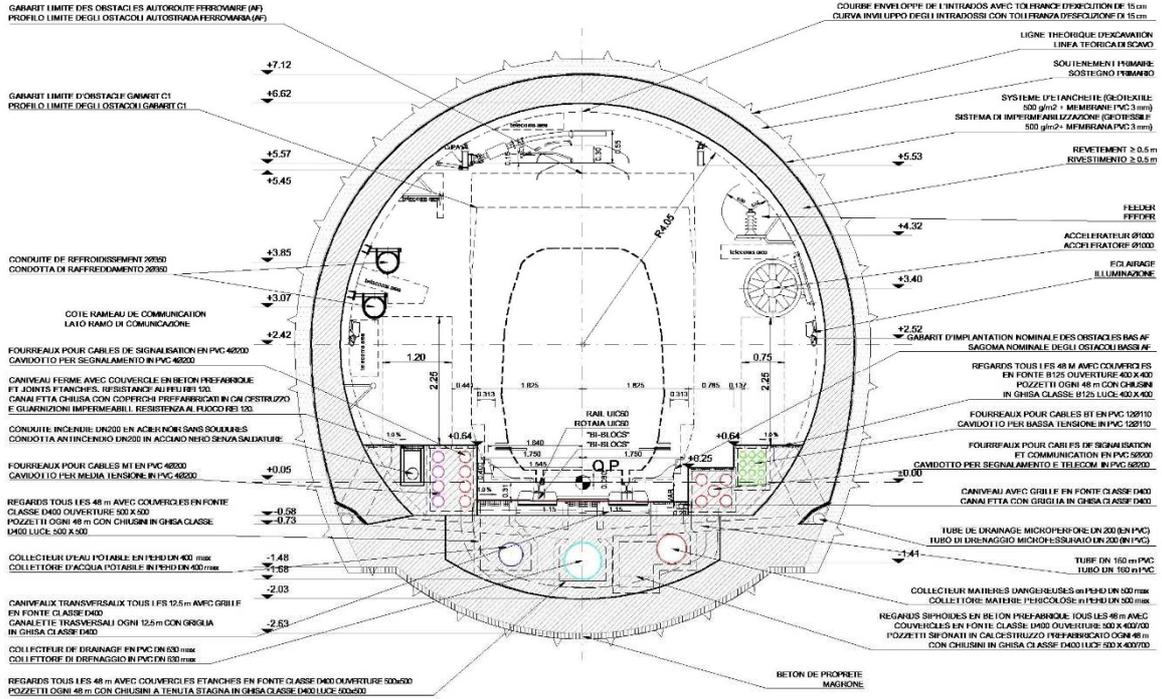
Sezione tipo Tunnel di Base: scavo in convenzionale
